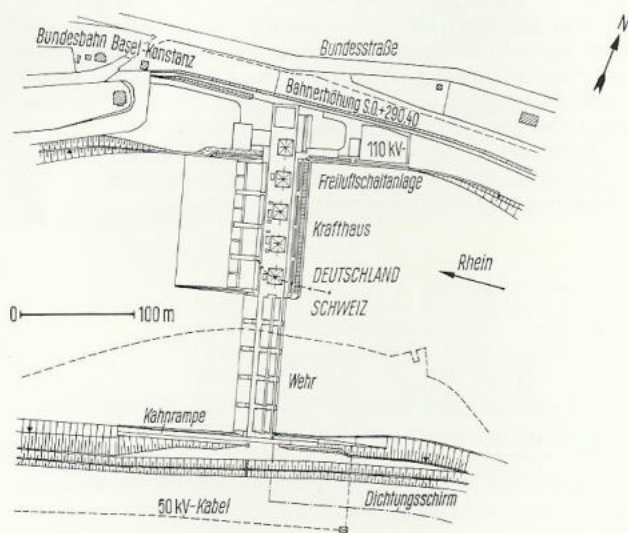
Grundriß des Rheinkraftwerks Säckingen
